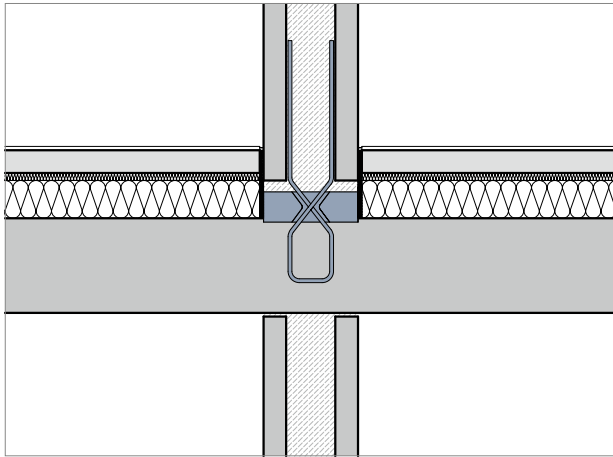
Schematische Darstellung Schöck Sconnex® Typ W bei Doppelwänden und Aufdeckendämmung
